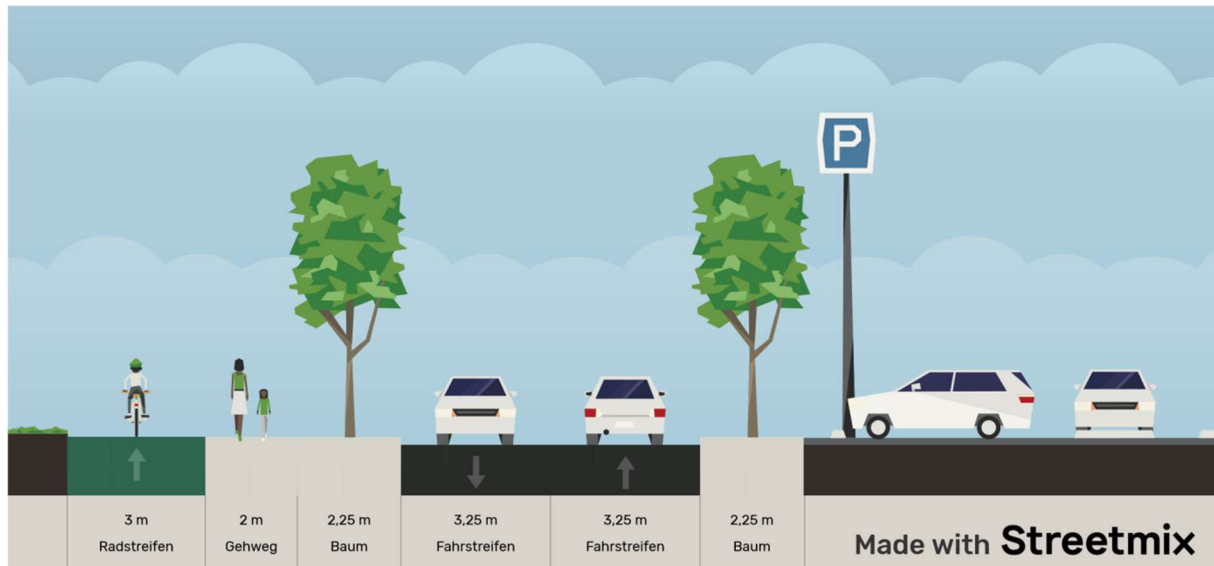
Schematische Darstellung des Querschnitts der Planstraße, ohne Normcharakter (Streetmix)
